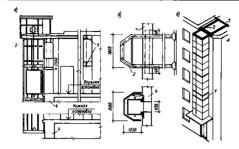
Конструкция наружного подвесного люфта:
